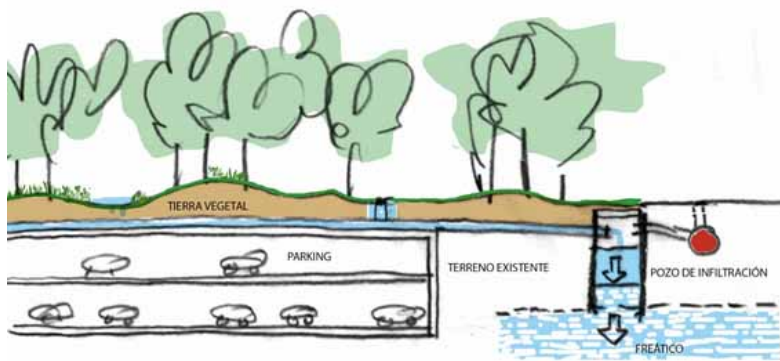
Plaza de les dones de Nou Barris. Detalle constructivo de área de biorretención.
